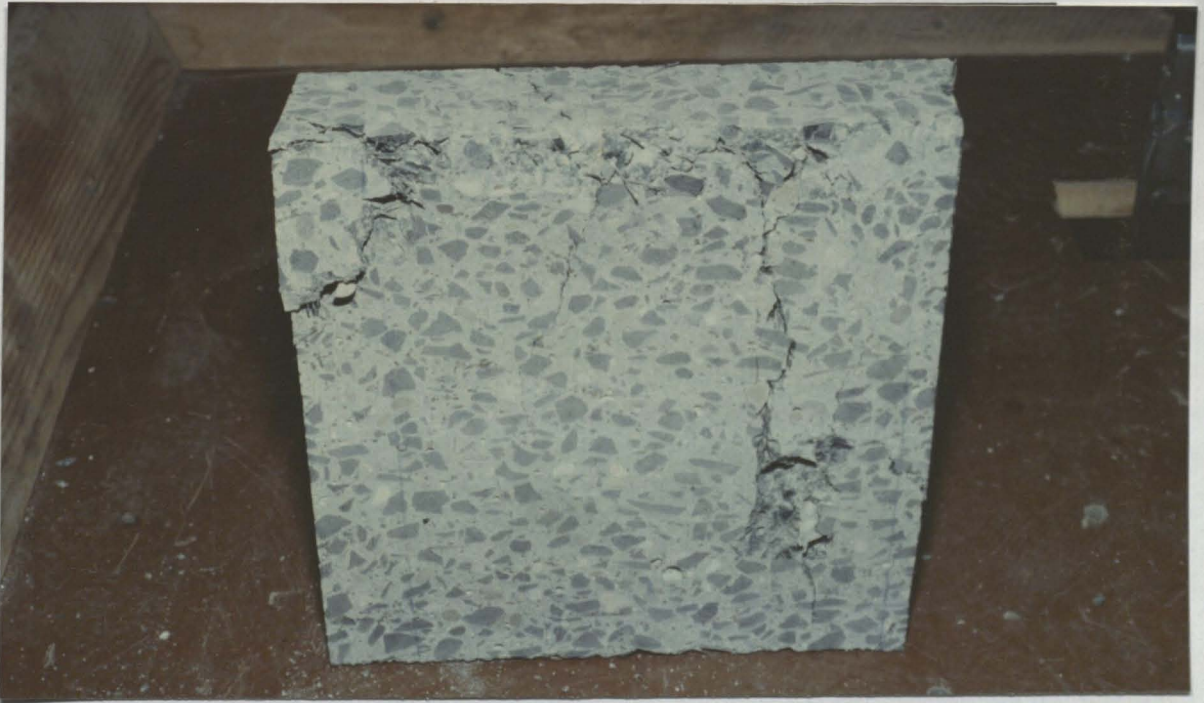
rückwärtige Ansicht der in Bild 39 gezeigten Probe.
